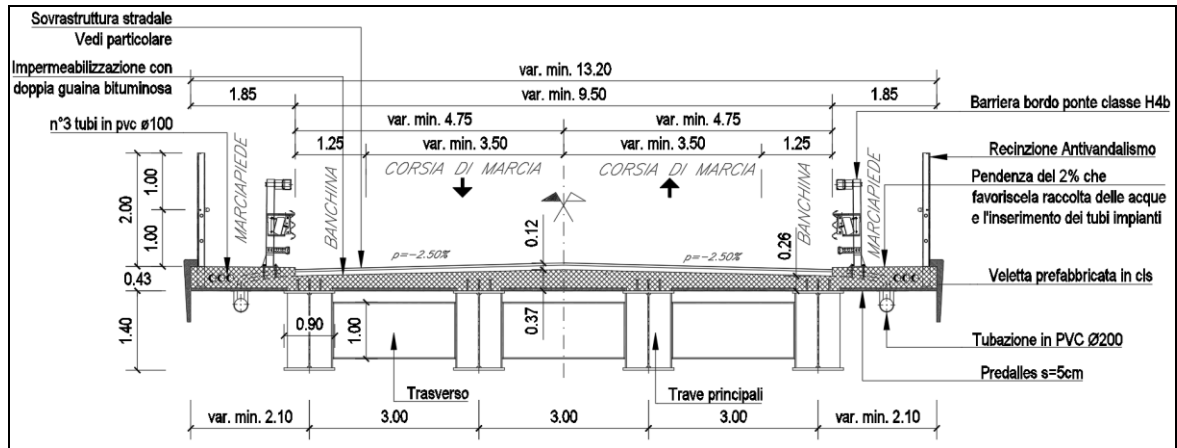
Viadotto IV02 su viabilità NV02B: sezioni trasversali e prospetto
